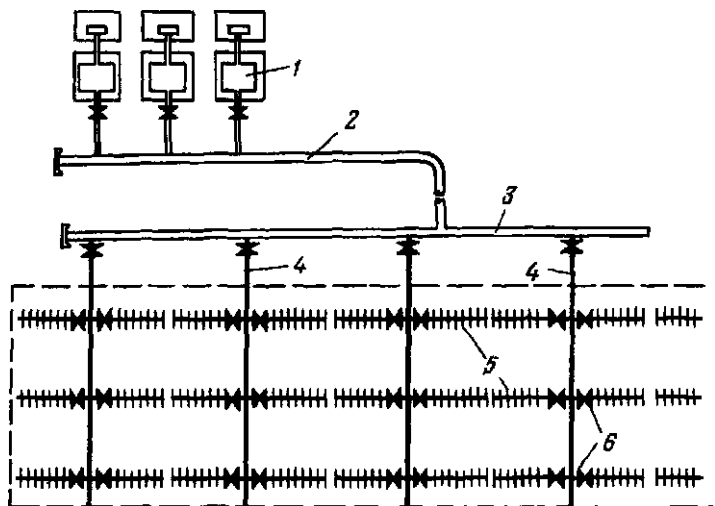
Схема водоснабжения игольной гидрооттайки:
